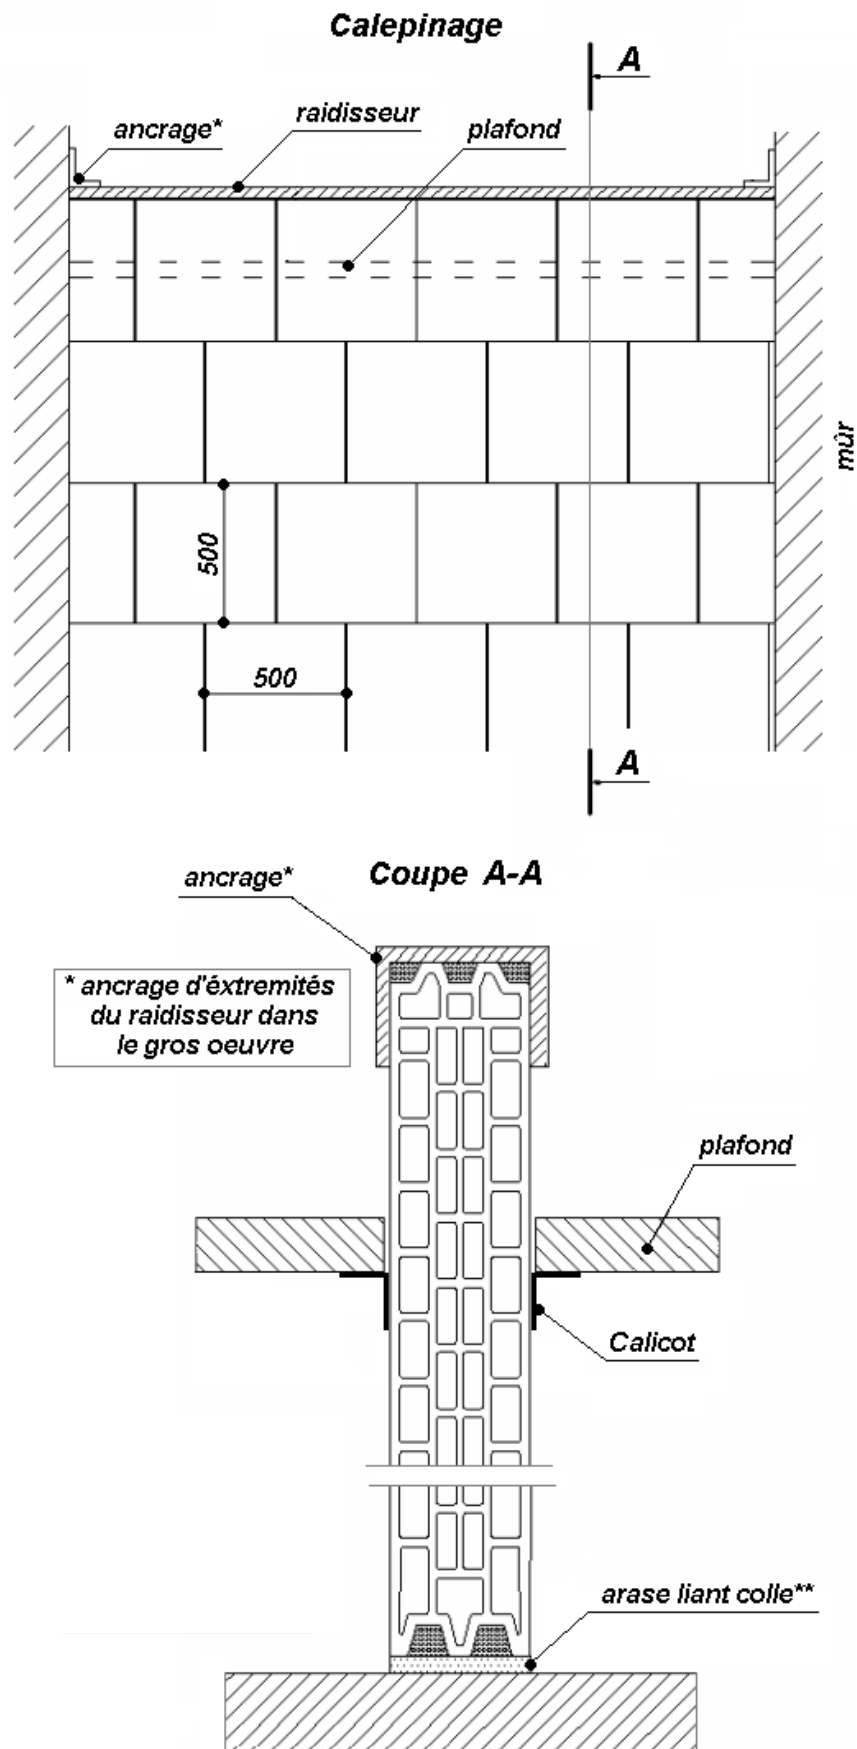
Raccordement en tête et en pied d'une cloison traversant un plafond suspendu
